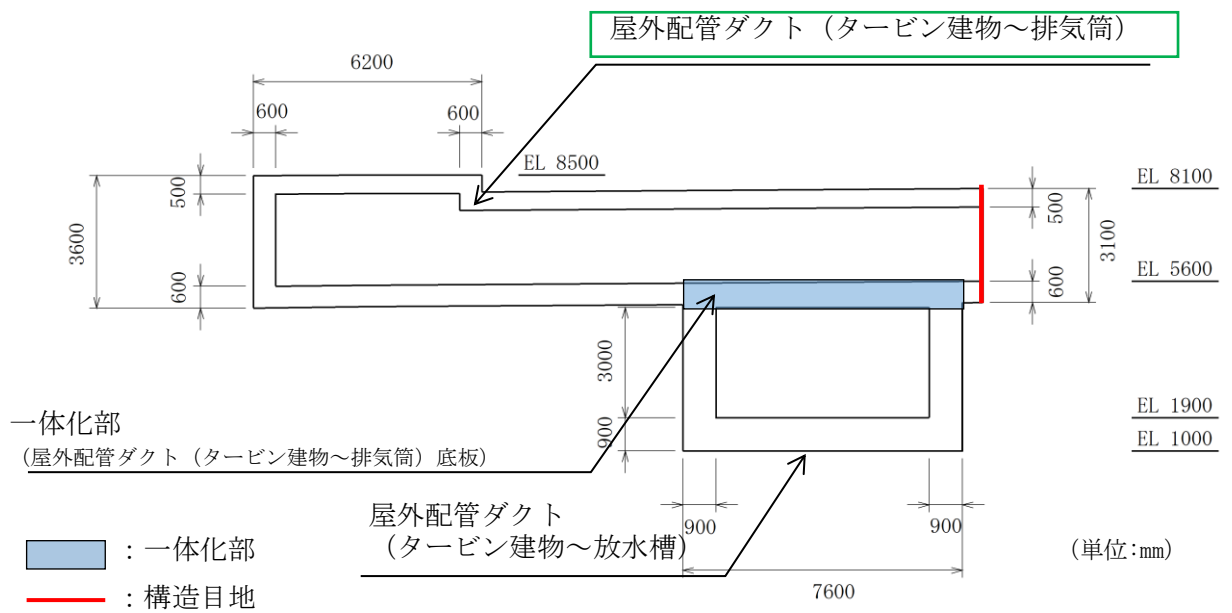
屋外配管ダクト (タービン建物～排気筒) 断面図 (C-C断面)
